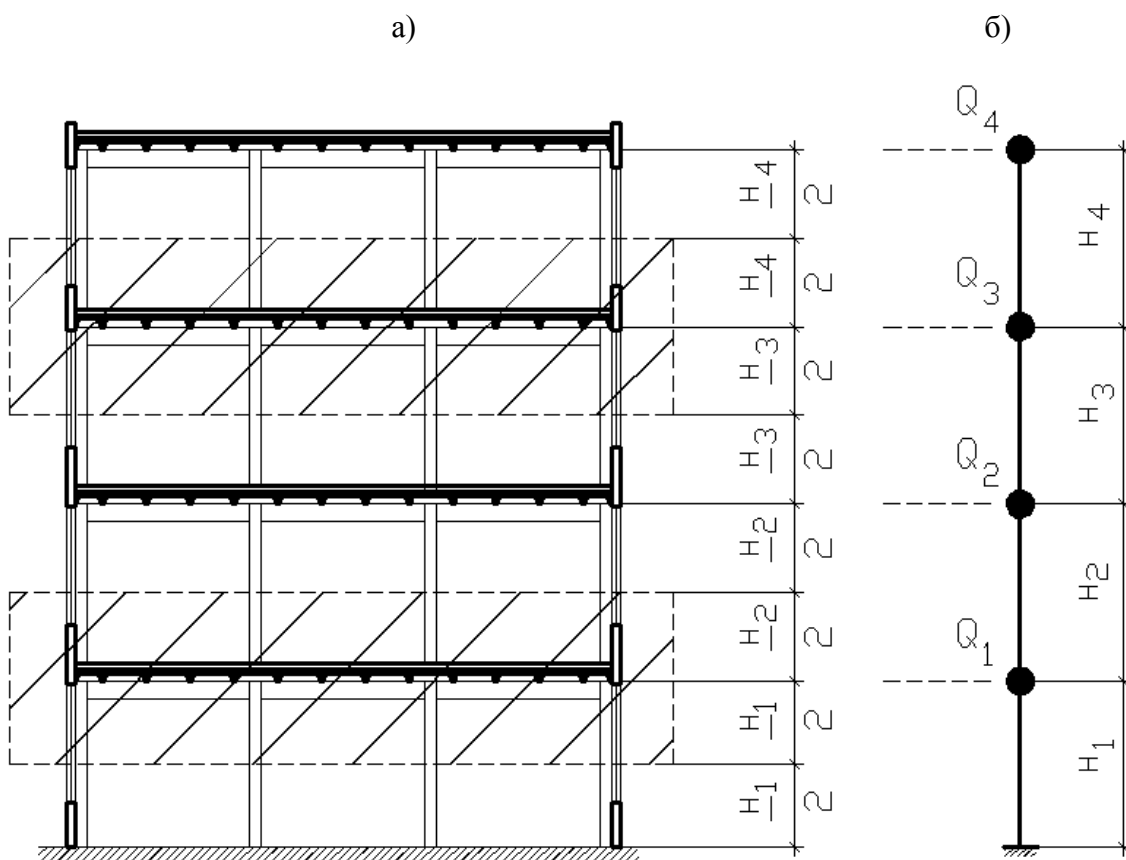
Формирование динамической расчетной схемы каркаса многоэтажного здания:
